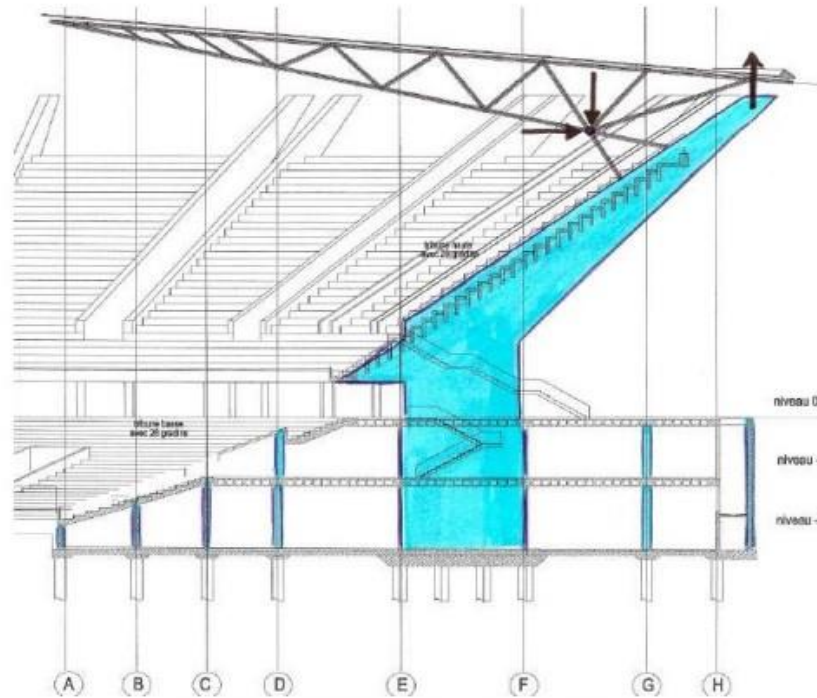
Coupe transversale et vue sur les principaux éléments verticaux
